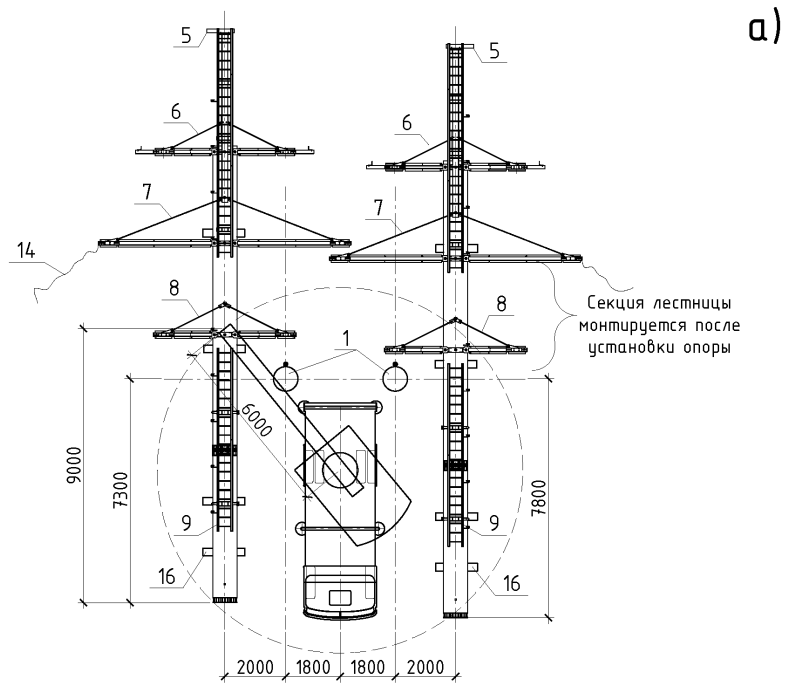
Схема сборки и монтажа опор 2СУБ110-2Ф
